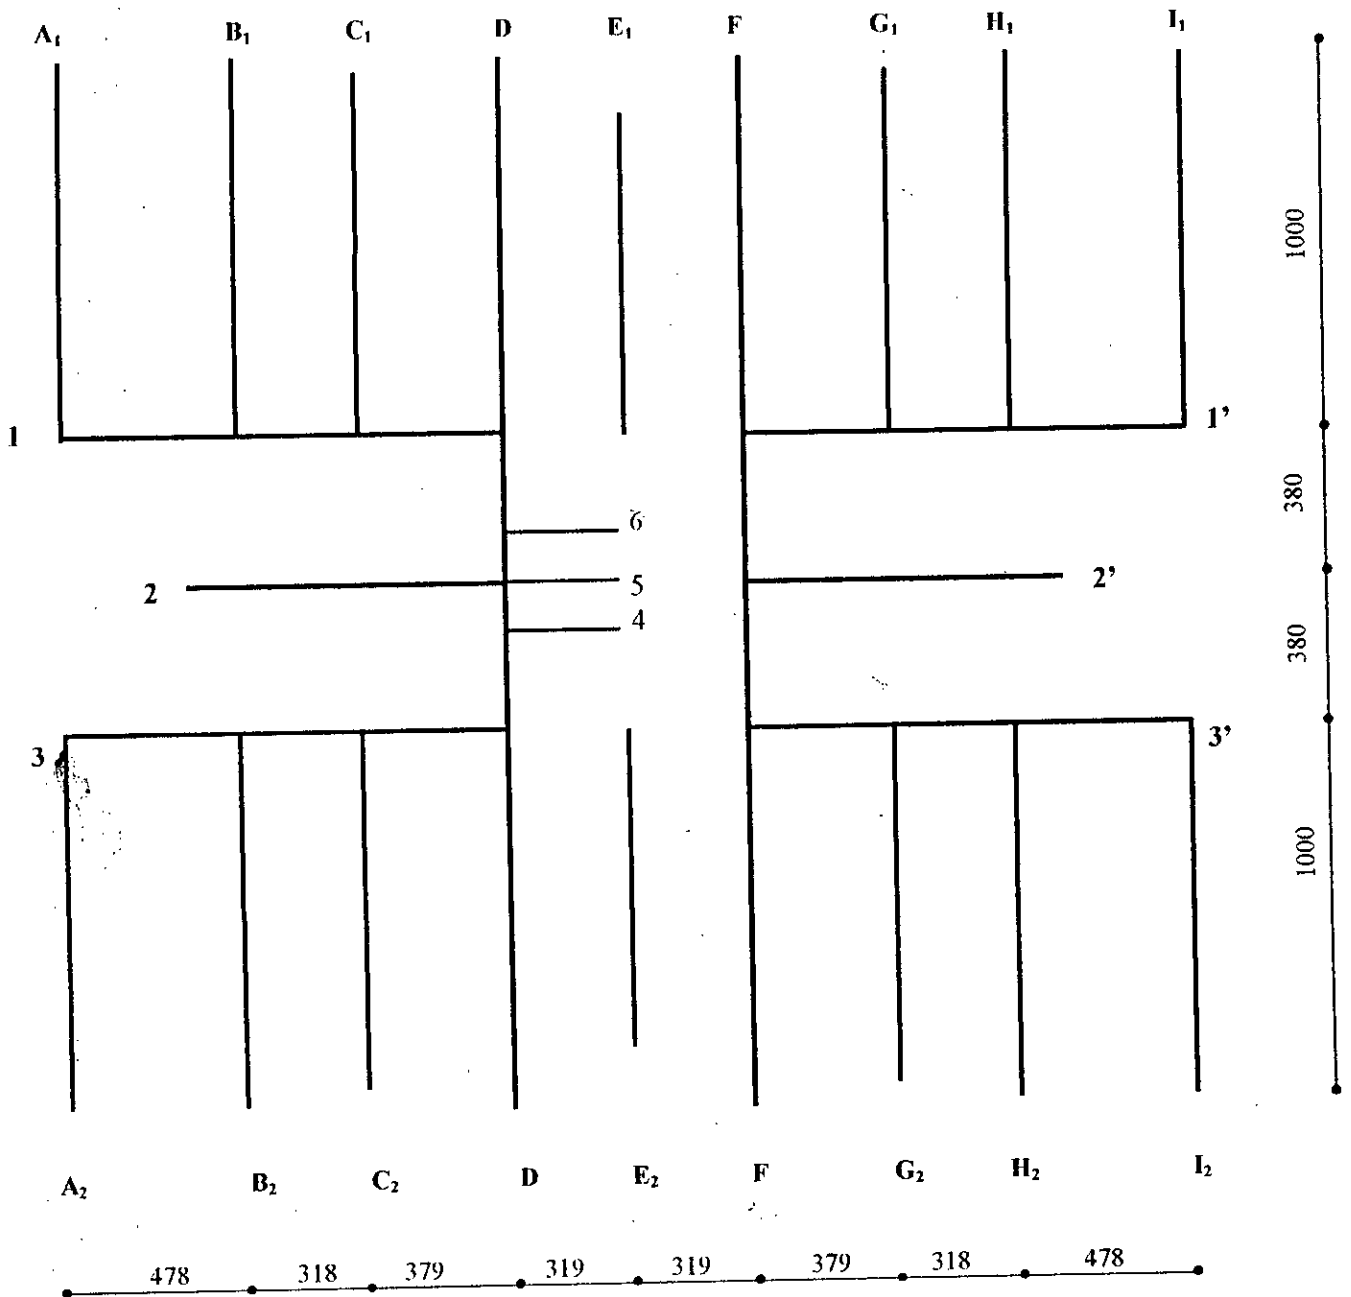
VUE EN PLAN DE L'ETAGE COURANT
